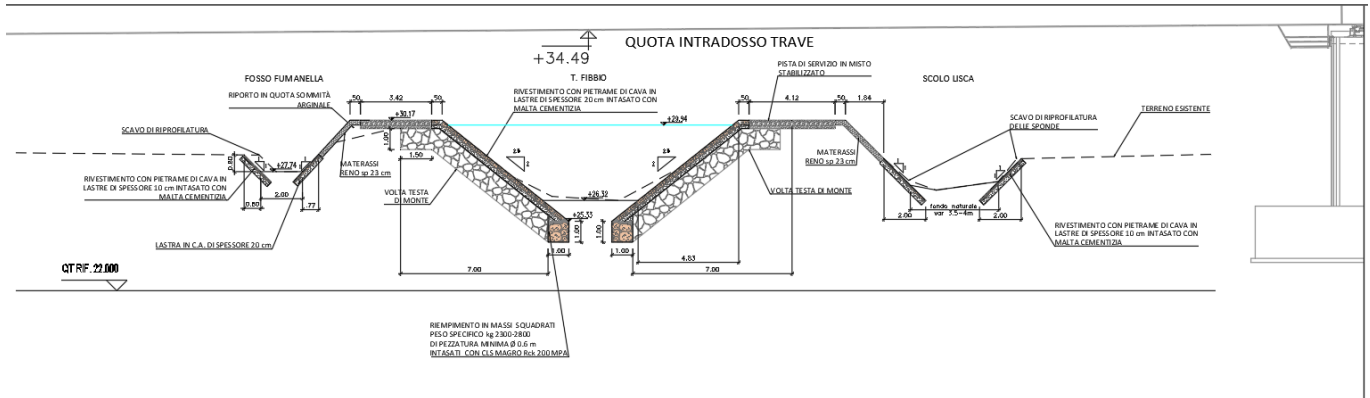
Torrente Fibbio – Sezione tipologica con rivestimento spondale di progetto.
